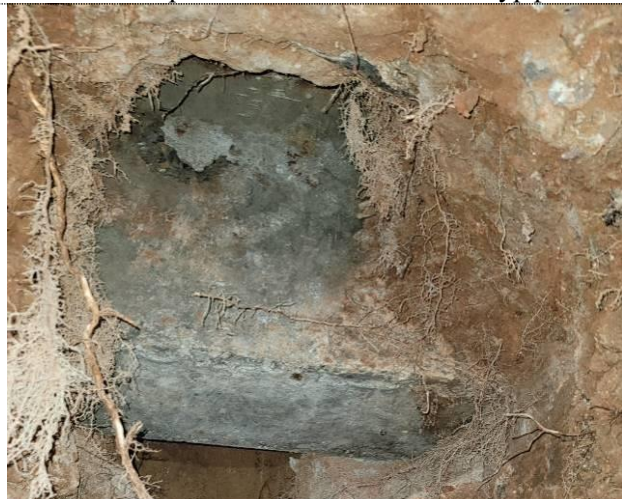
Шурф №4 фрагмент сборной железобетонной фундаментной балки
